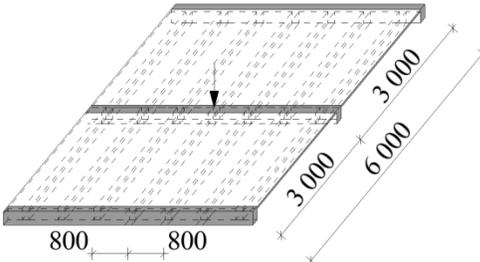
Схема поперечного сечения фрагмента часторебристого перекрытия
